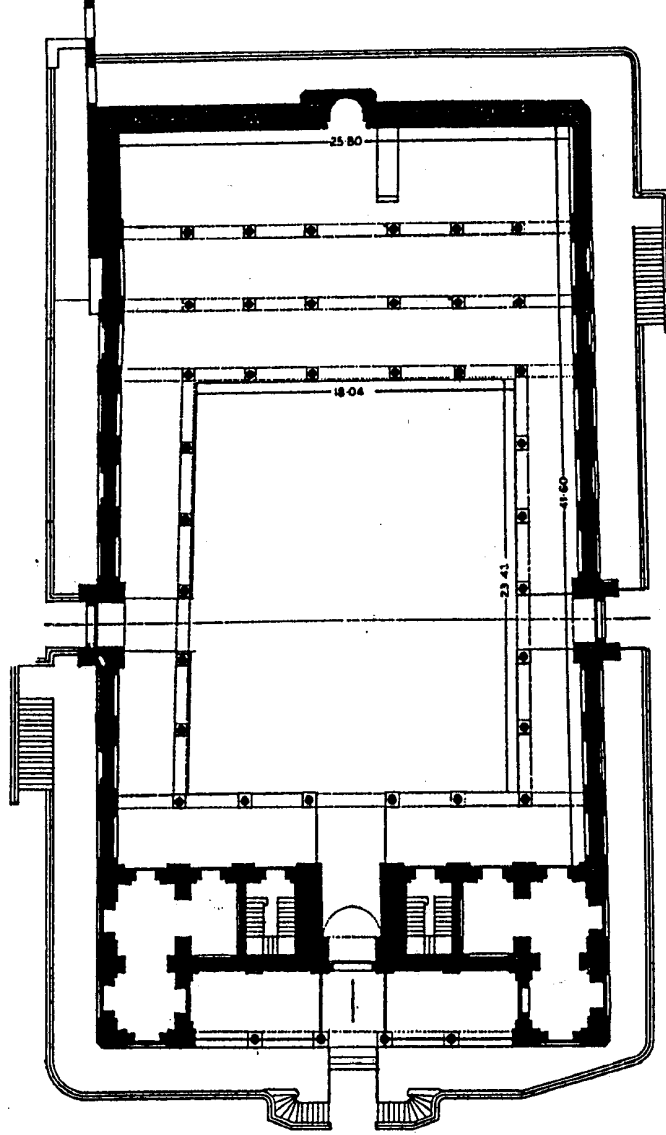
مسقط أفقي لجامع حران (عن : أحمد فكري)
